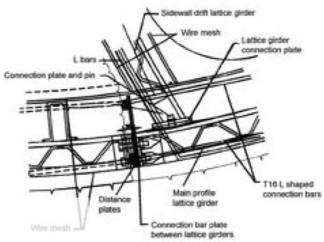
Метод боковых штолен. Стык временной боковой стенки с основной обделкой обычно сильно армируется (как показано на схеме). Для такого соединения требуется хорошее уплотнение набрызгбетона для обеспечения стабильности крепи после разработки всего сечения тоннеля.
